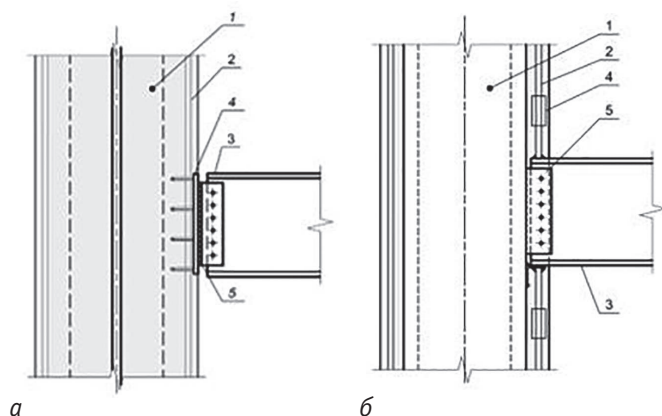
Примеры примыкания стальной балки к сталежелезобетонной колонне
